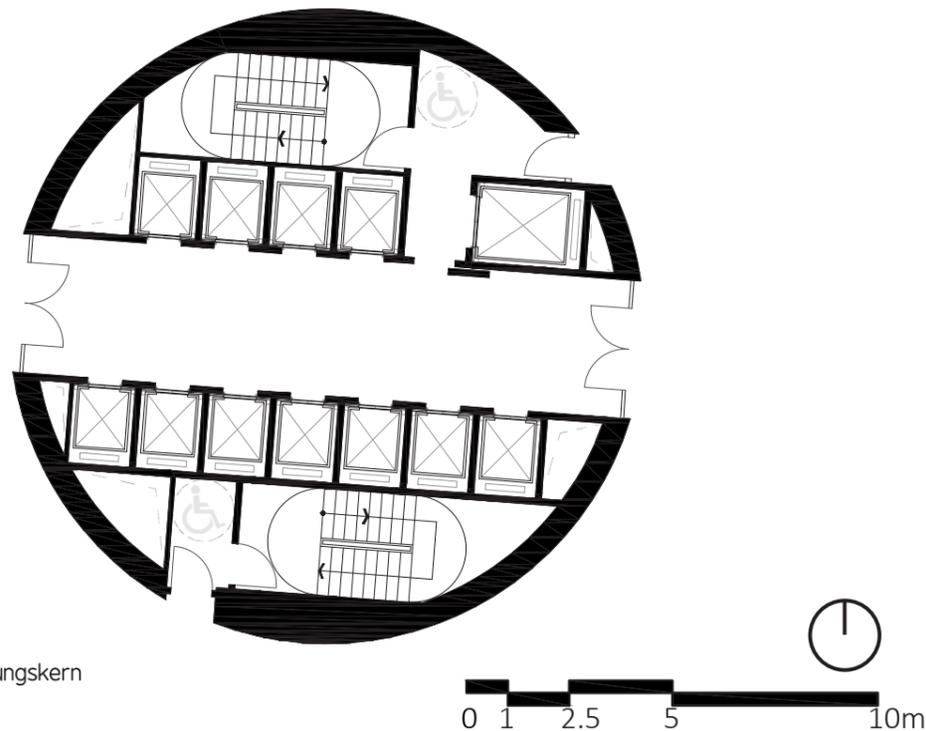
Grundriss Erschließungskern (eigener Plan)
